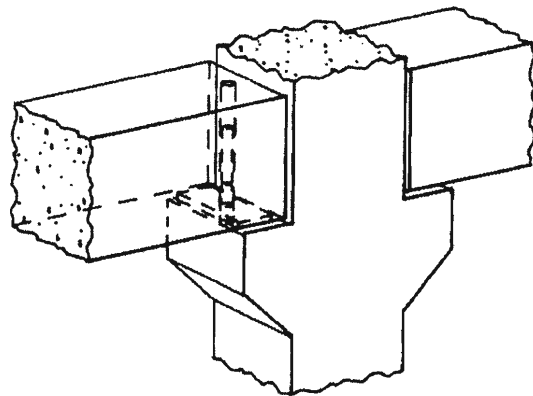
Unión típica columna-viga. (Ref. 33)
